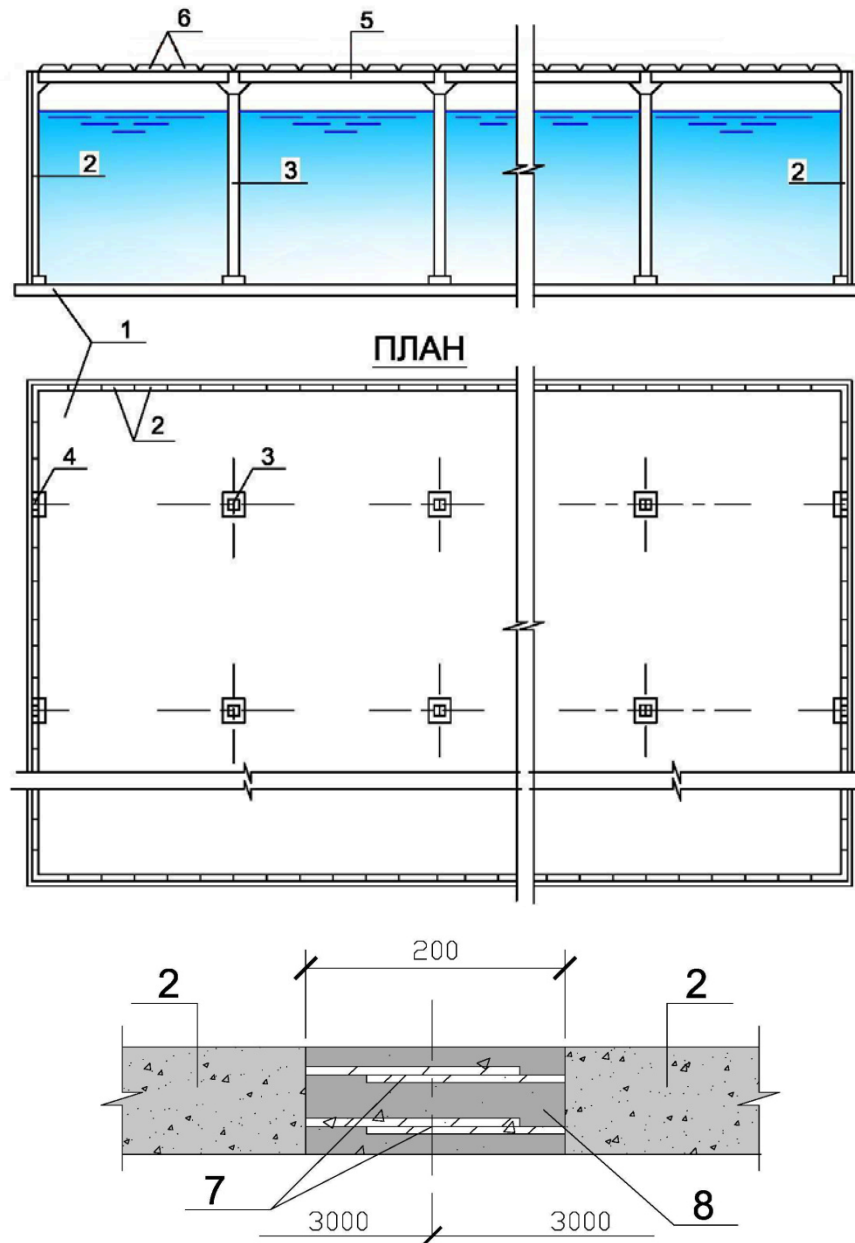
Схема прямоугольного резервуара из сборных железобетонных панелей:
